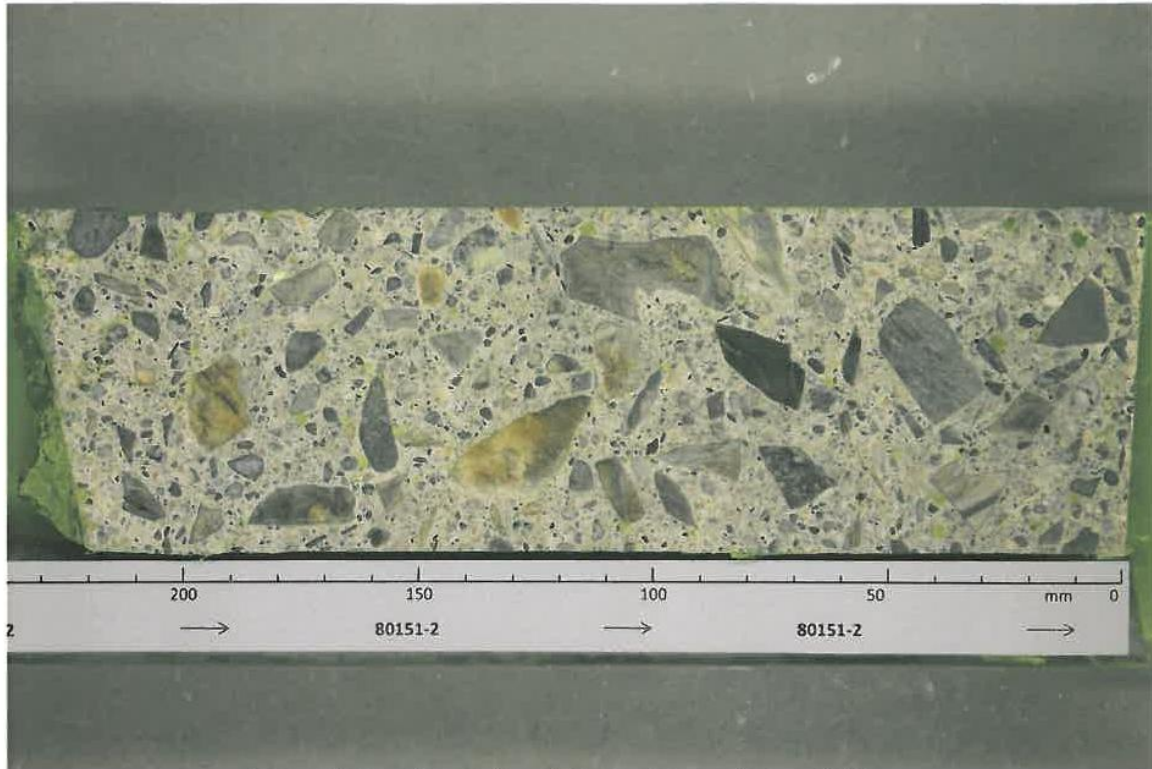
Planslipet fra kjerne Nr 2. Overflaten til høyre på bildet.
